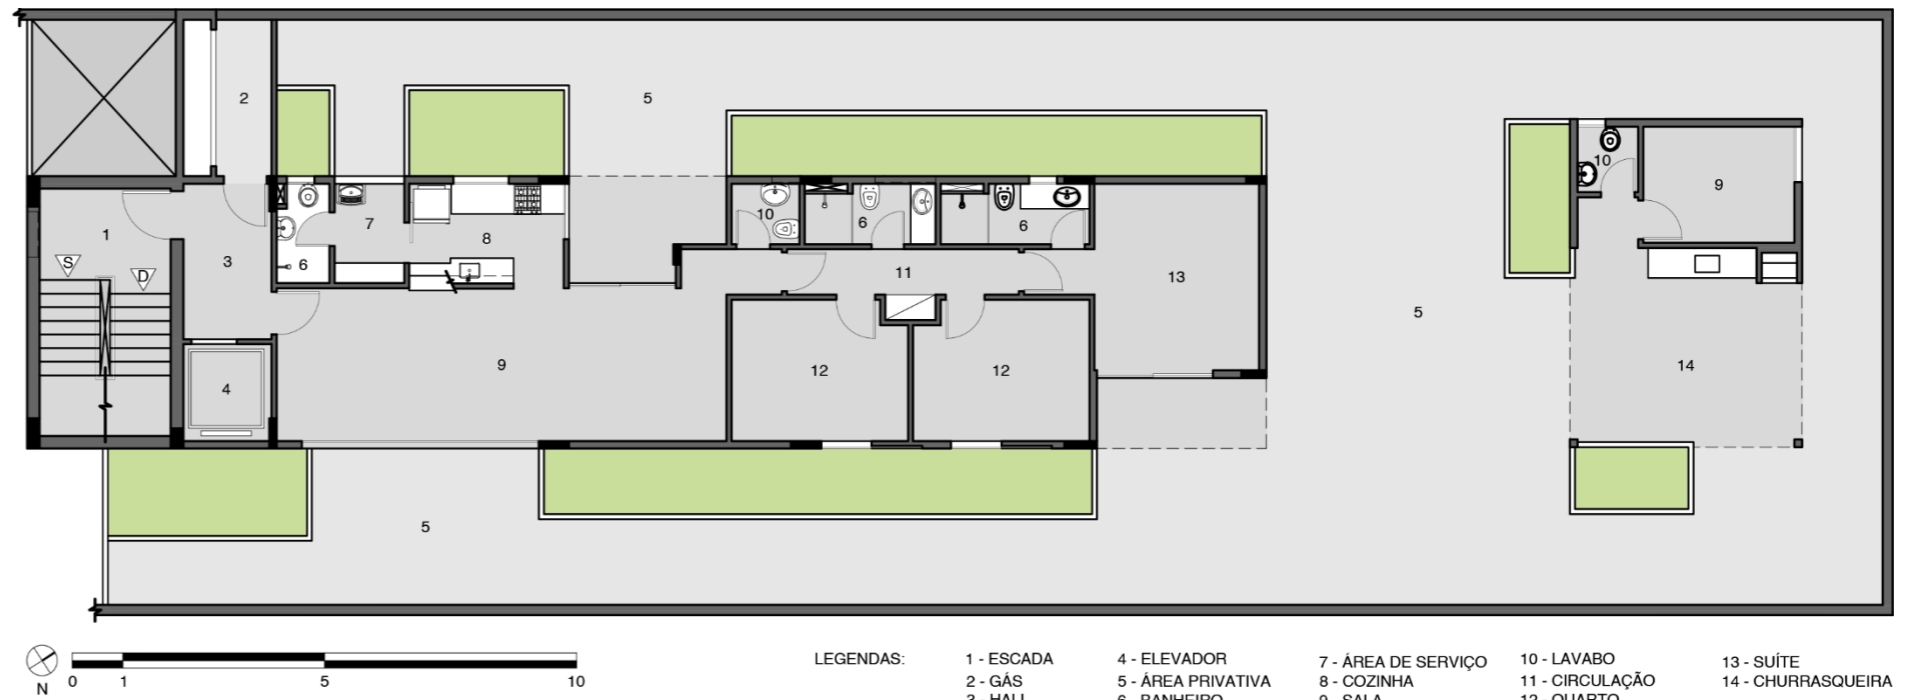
Planta do segundo pavimento do Montevidéu 285
